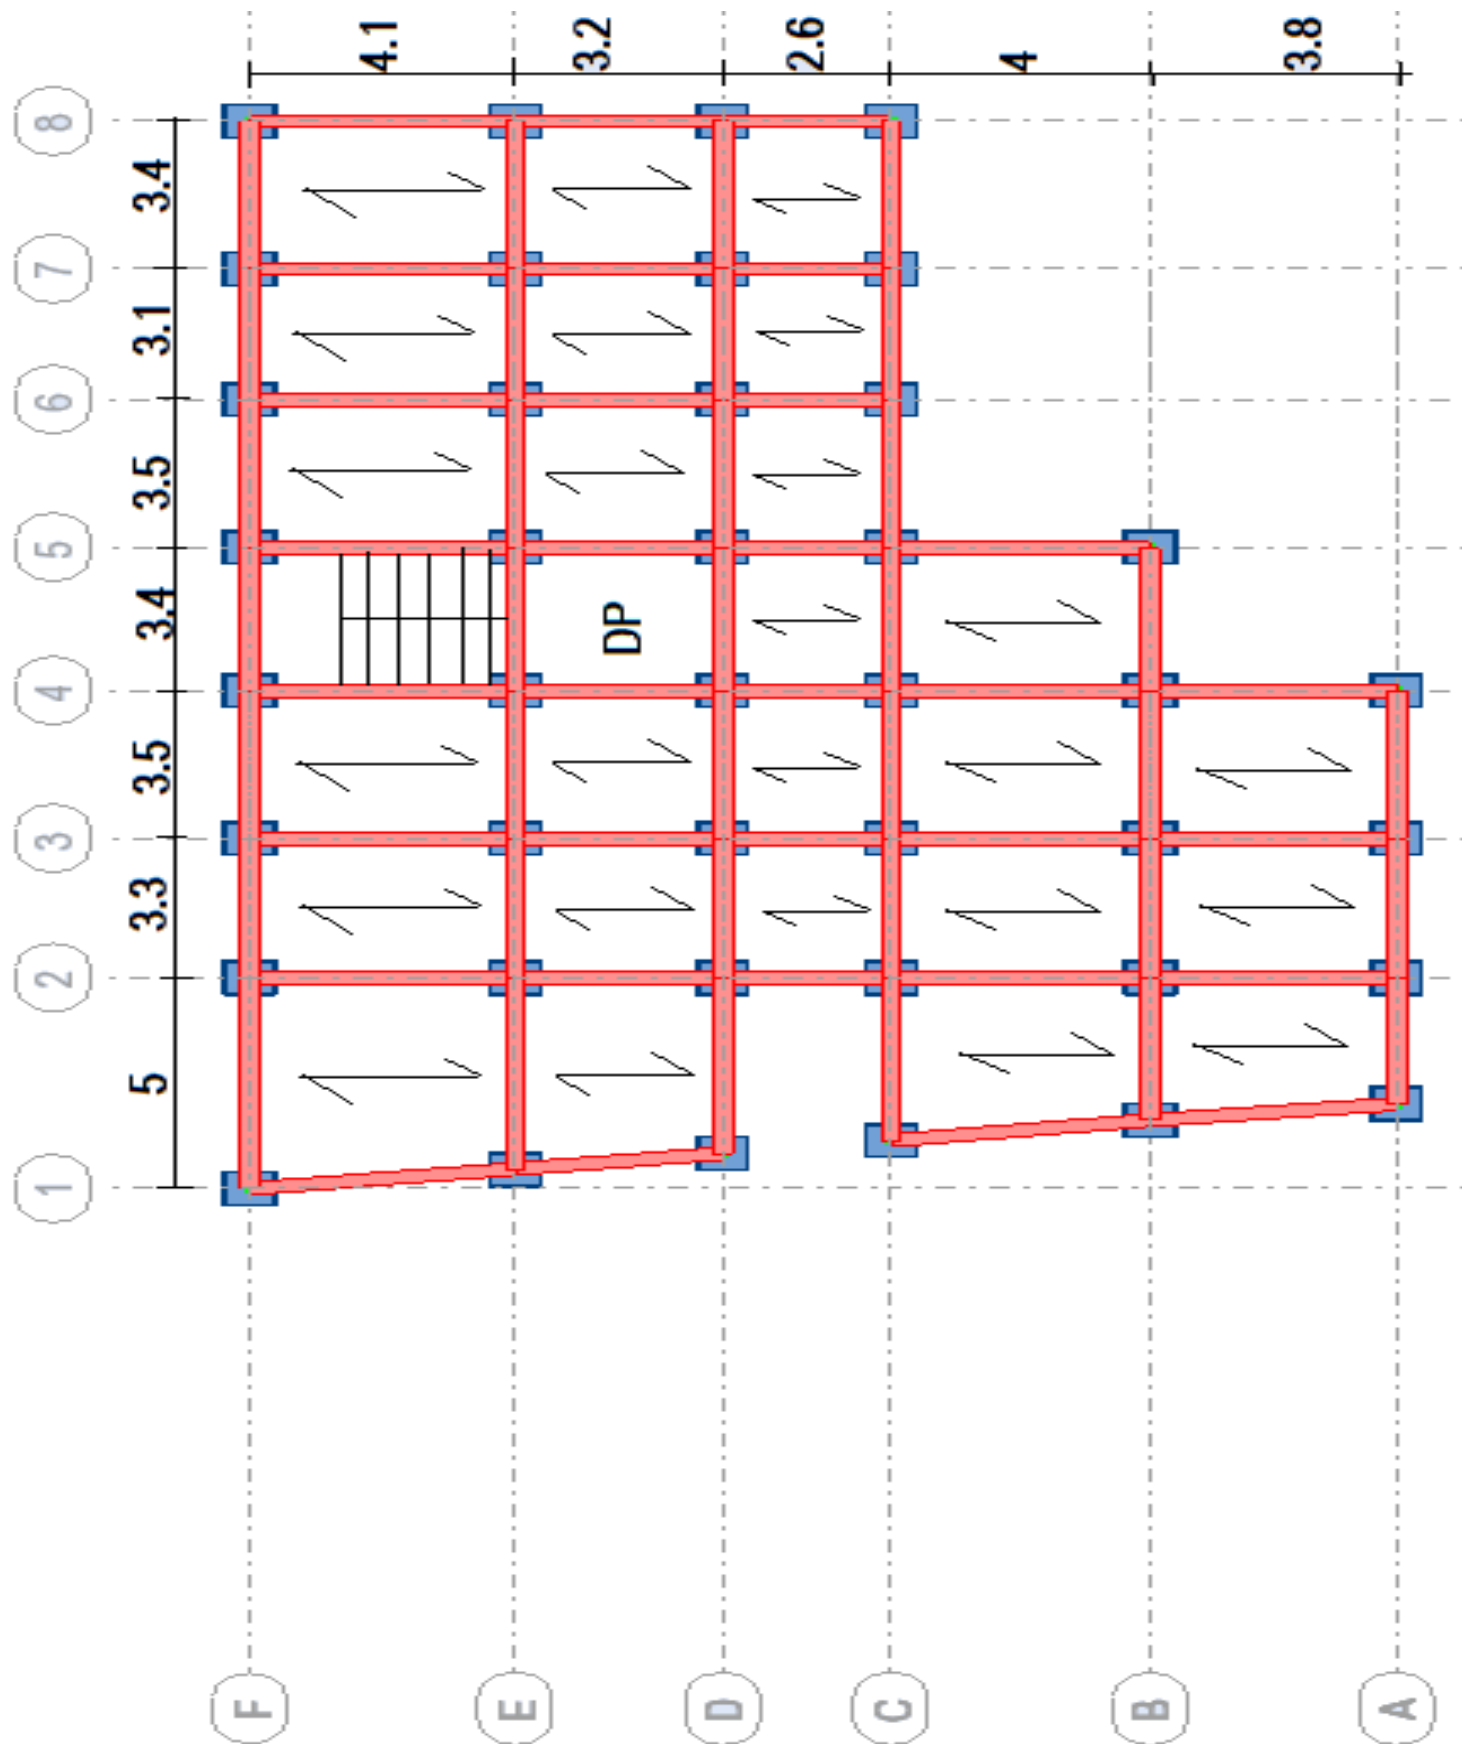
vue en plan du plancher et la disposition des poutrelles
